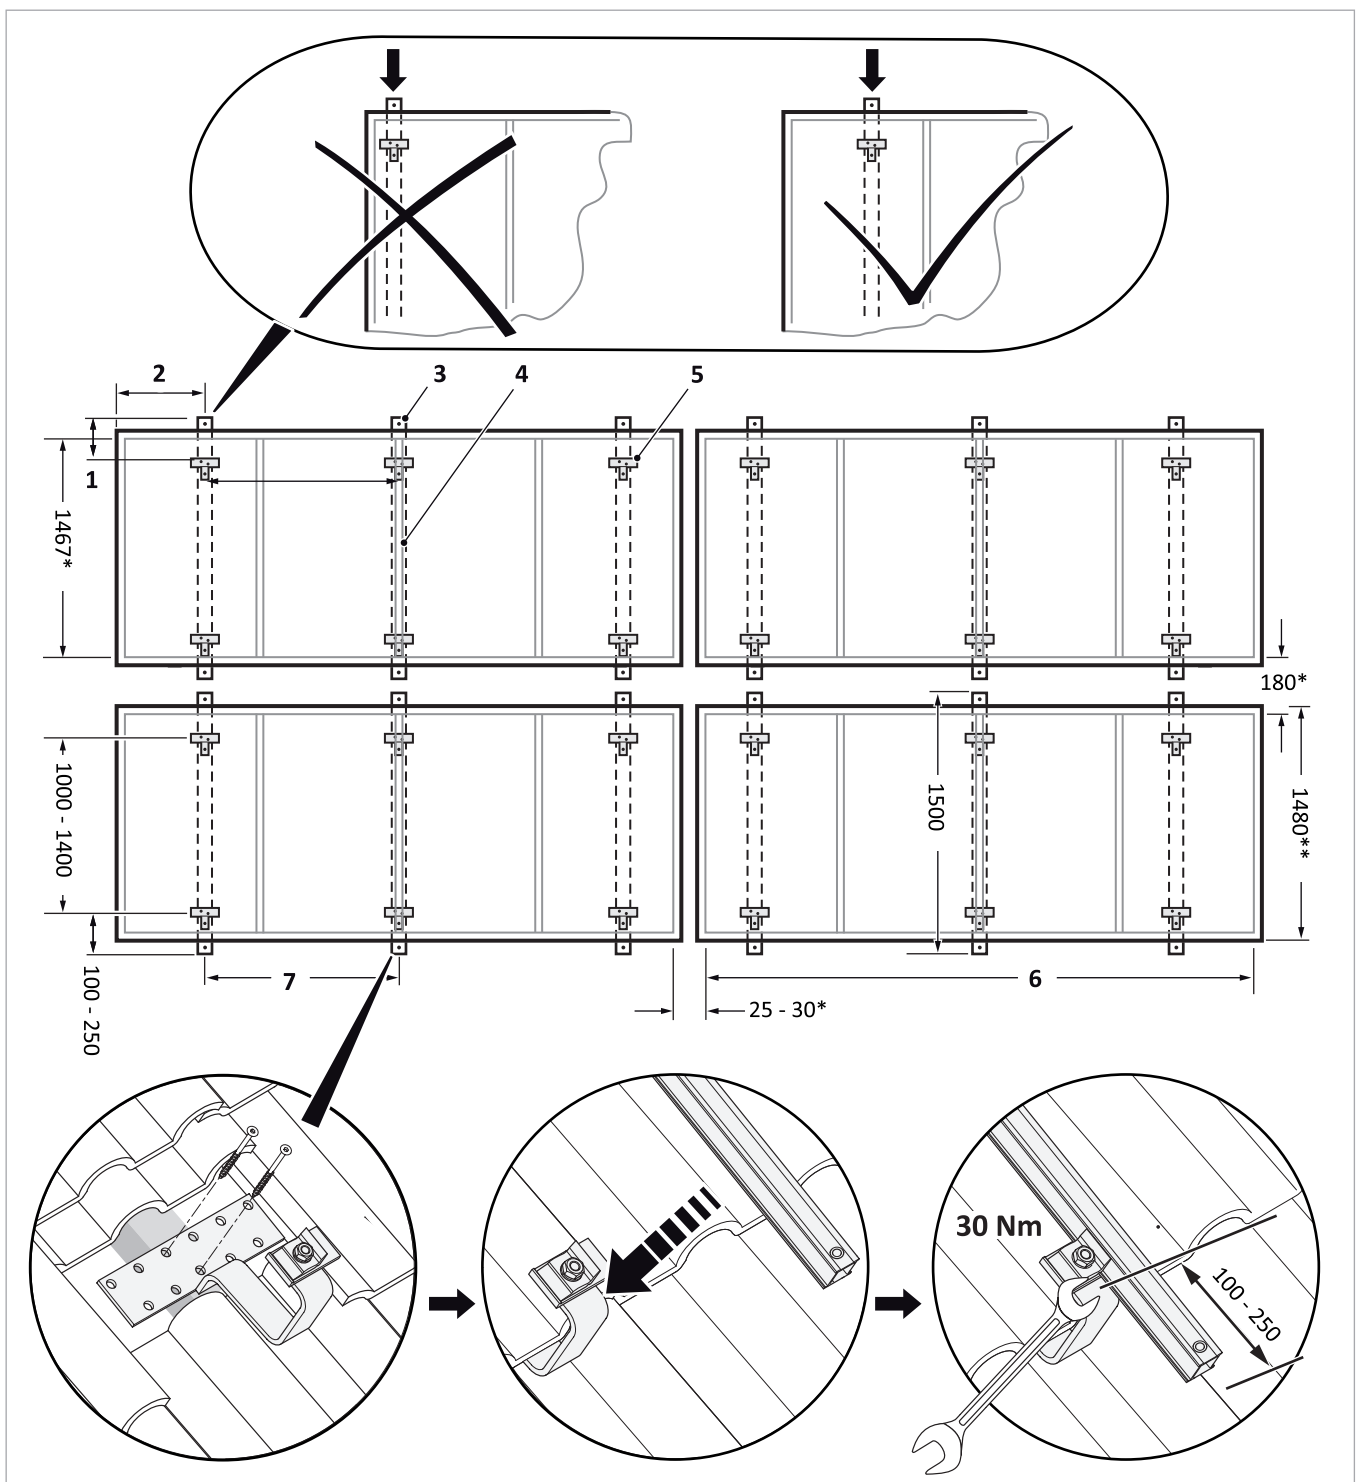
Montage Dachhalter / Halteschienen. Dachhalter-Typ variiert je nach Art der Dacheindeckung. Montageanleitung des Dachhalters beachten!
